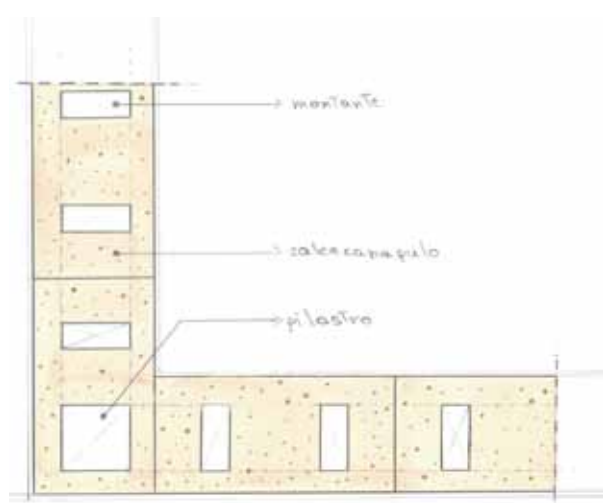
Disposizione della struttura nel sistema con blocchi forati in calcecanapulo
